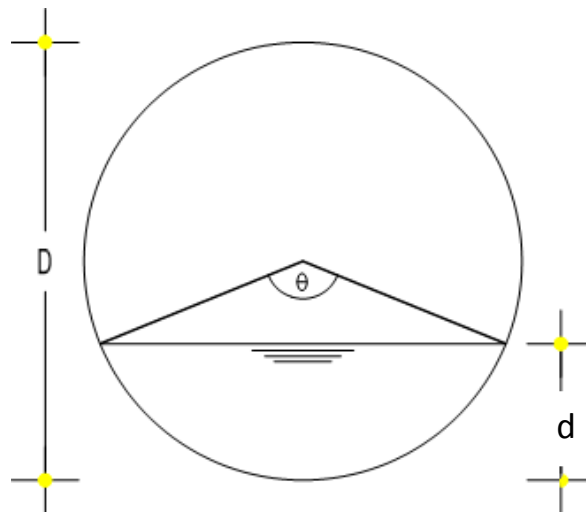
Sección de una Tubería Parcialmente Llena
